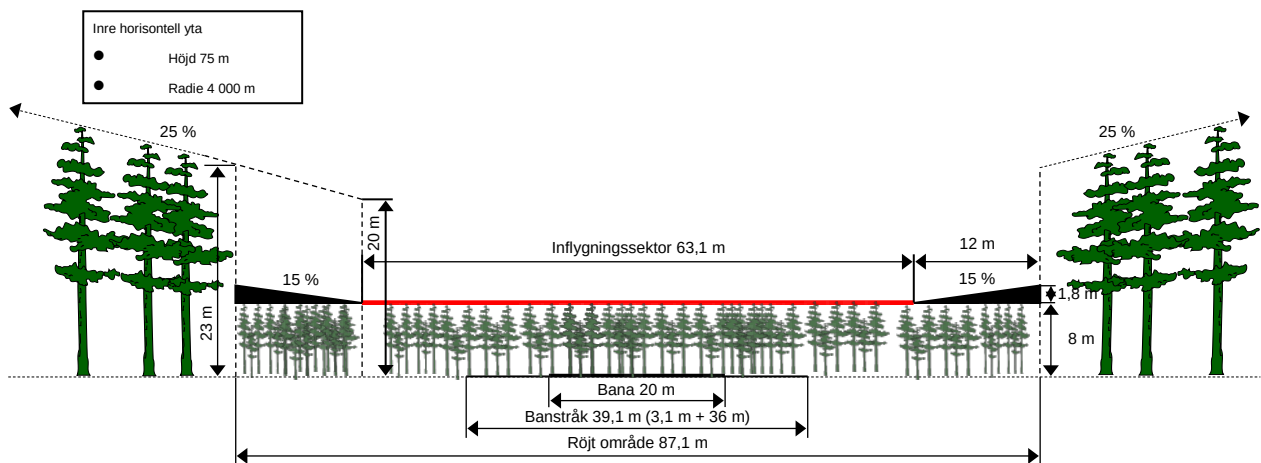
Tvärprofil av banstråksänden A-A 400 m inåt (HN)
